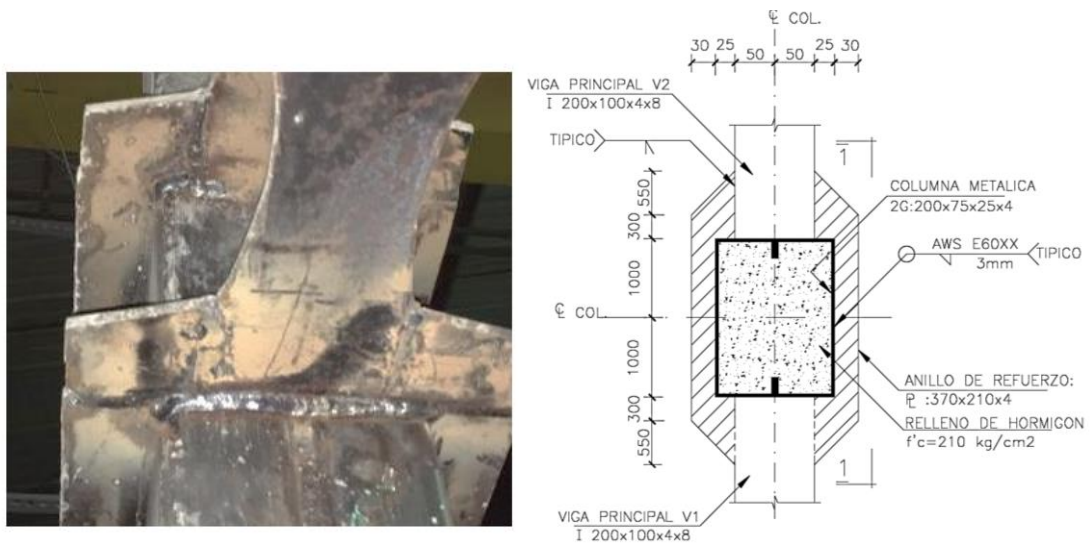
Unión con refuerzo exterior rectangular
